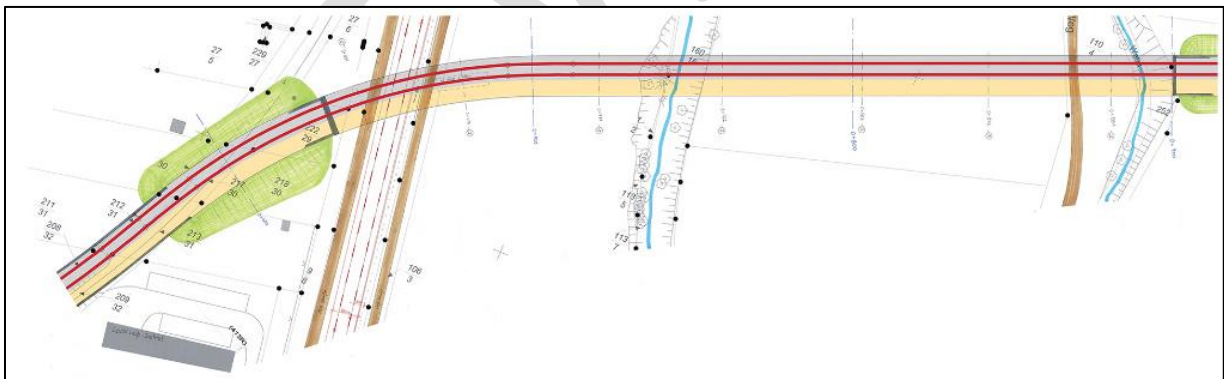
Projektteil Campusbahn/Querum, Lageplan Brückenentwurf 2 und 3, Stand Machbarkeitsuntersuchung
